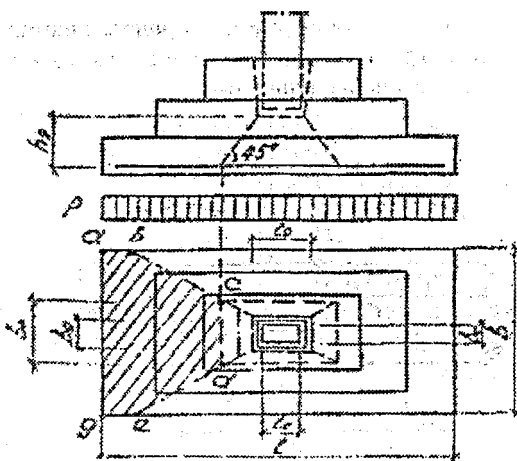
Схема образования пирамиды продавливания для стаканного фундамента
